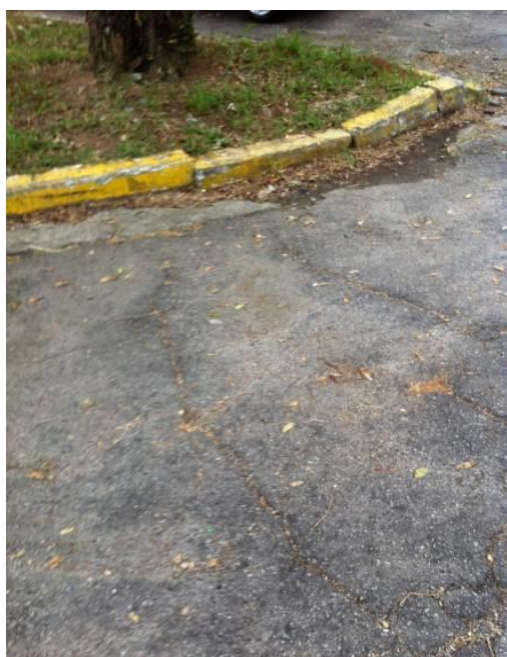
Foto das fissuras presentes no pavimento nas vias da CUASO
